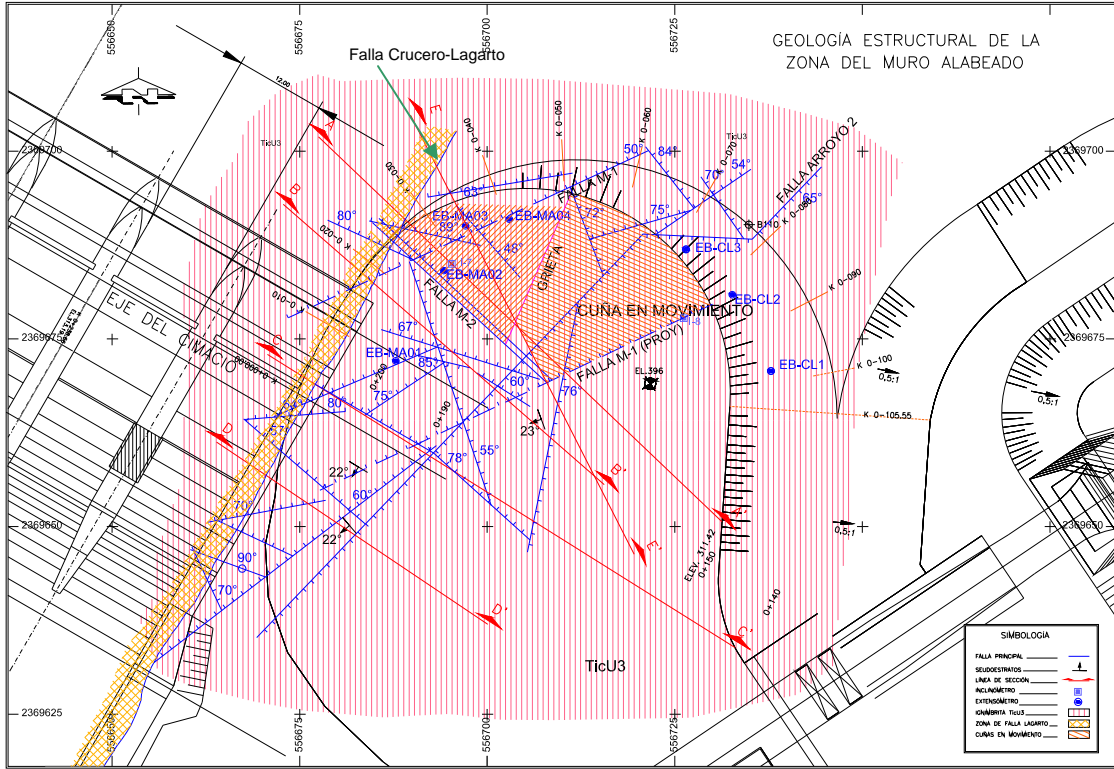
Planta geológica del muro alabeado donde se observan las estructuras principales.
